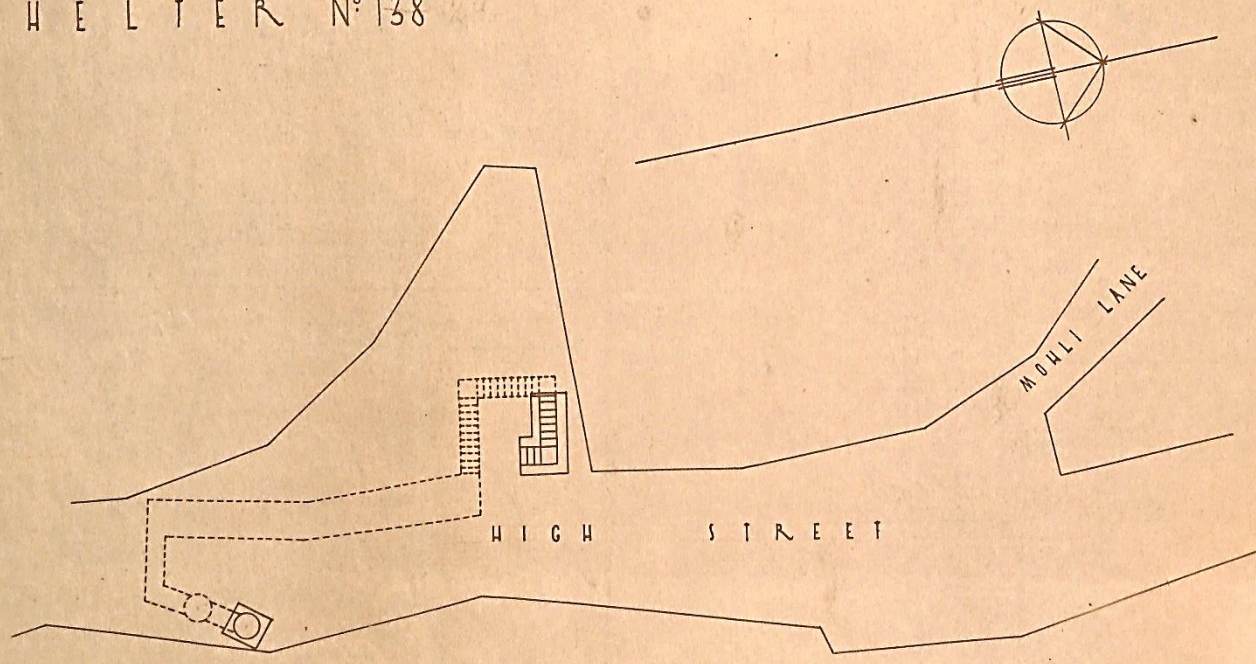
Planta do Abrigo nº 138 (29) "High Street – Mouli Lane."
